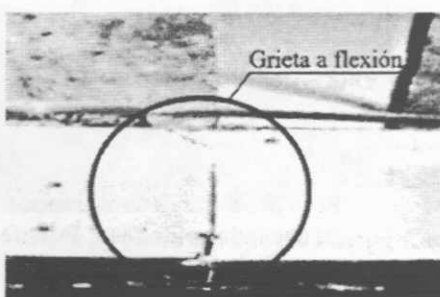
Falla a flexión en viga transversal de puente de armadura. Puente Regional Risaralda.
